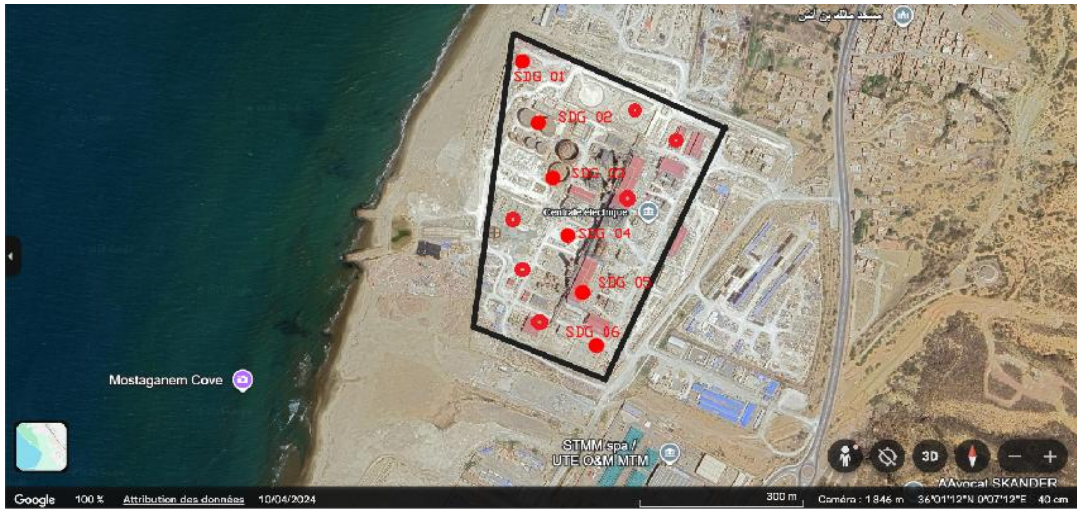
Le plan d'implantation des sondages pour les essais CPT.
